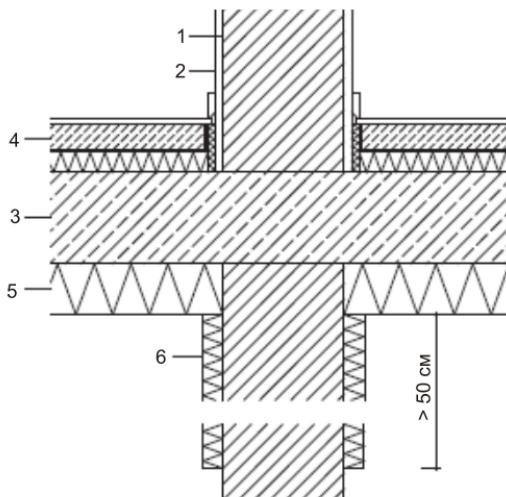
Теплоизоляция подвального перекрытия снизу, при одновременном устраниении "теплового мостика" в месте стыка перекрытия с разделительной стеной: 1 — разделительная стена; 2 — внутренний слой штукатурки; 3 — бетонное перекрытие; 4 — покрытие пола с плавающей стяжкой; 5 — теплоизоляция под бетонным перекрытием; 6 — дополнительная теплоизоляция стыков разделительной стены
